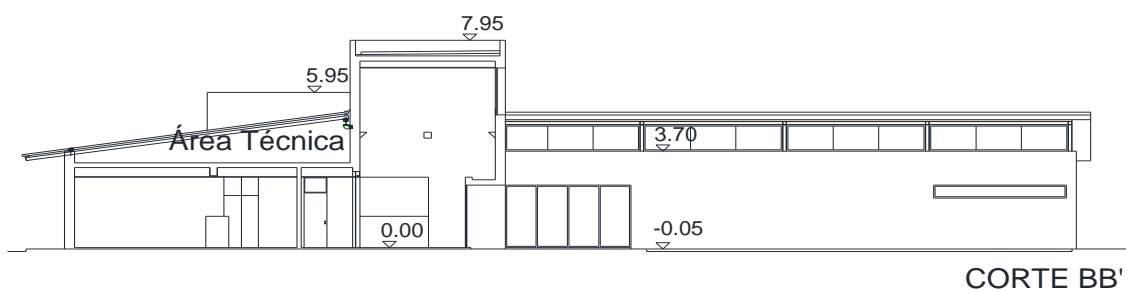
Corte BB' indicado na planta da fig. 36.
